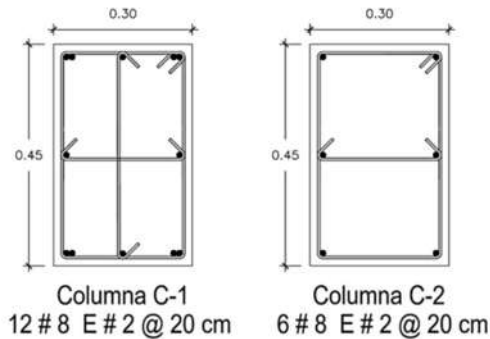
Secciones transversales y detallado del acero de refuerzo longitudinal y transversal de las columnas del edificio de 3 niveles (Tomado de: Olvera, 2020).
